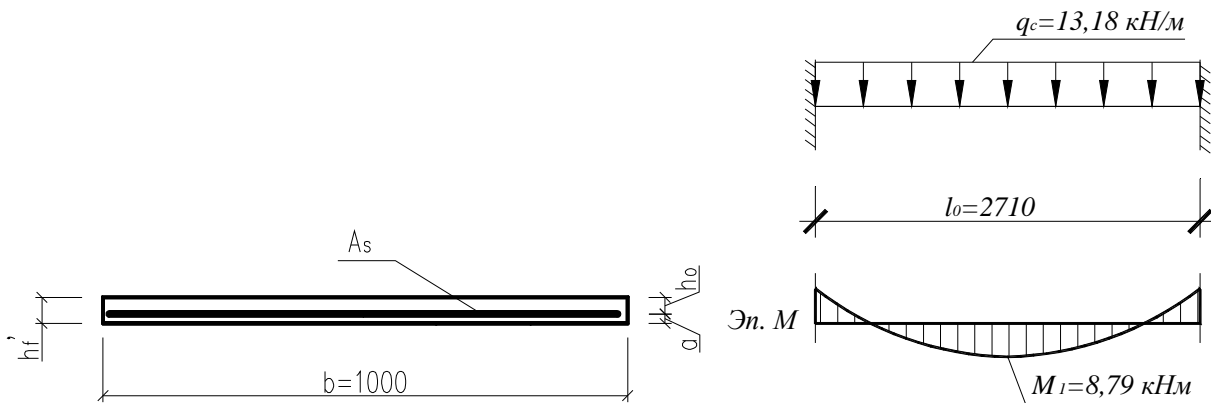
Приведенное сечение полки марша, расчетная схема и эпюра момента
